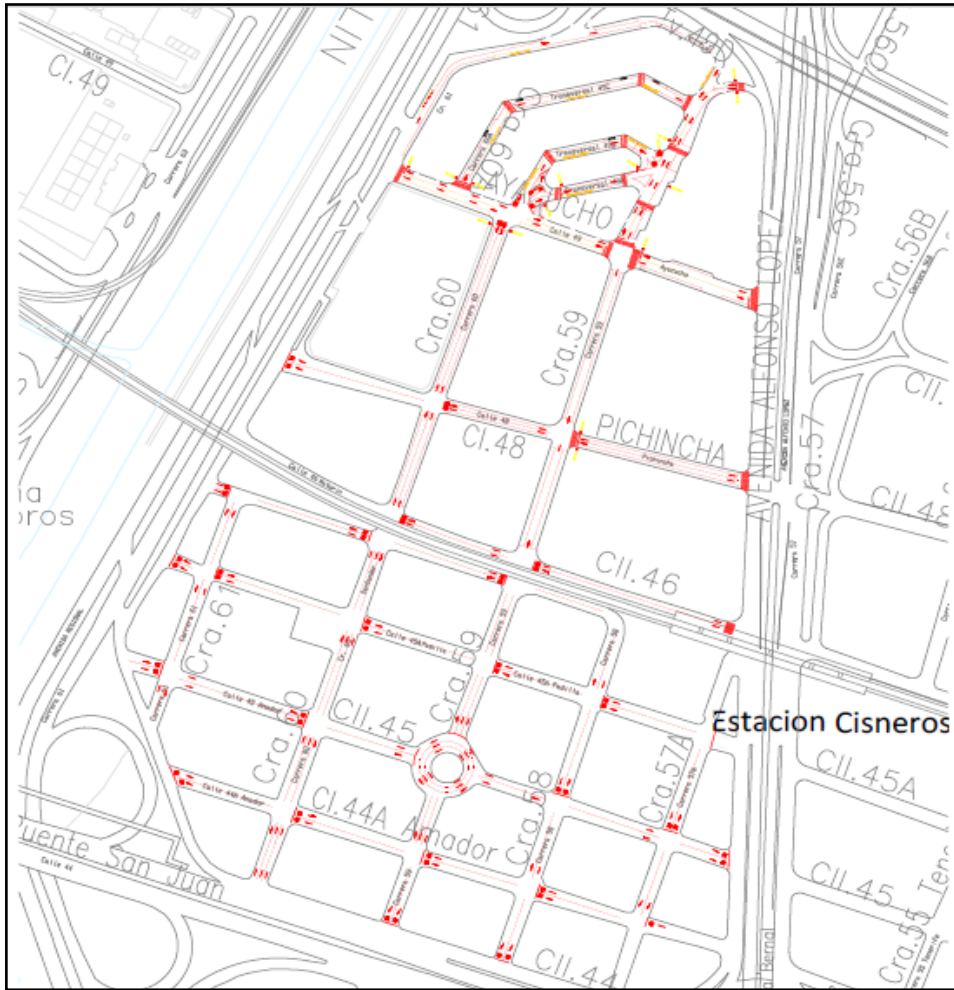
Plano diseñado en AutoCAD que recolecta los levantamientos en campo de Centro Parrilla para el barrio Corazón de Jesús
